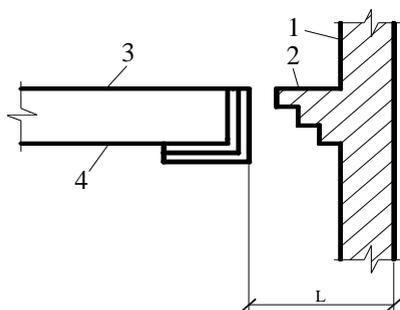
Схема горизонтальной разделки: 1 – стенка дымовой трубы; 2 – разделка; 3 – перекрытие, выполненное из сгораемого материала; 4 – дополнительная защита перекрытия от возгорания (2 слоя строительного войлока, пропитанного глиняным раствором)
